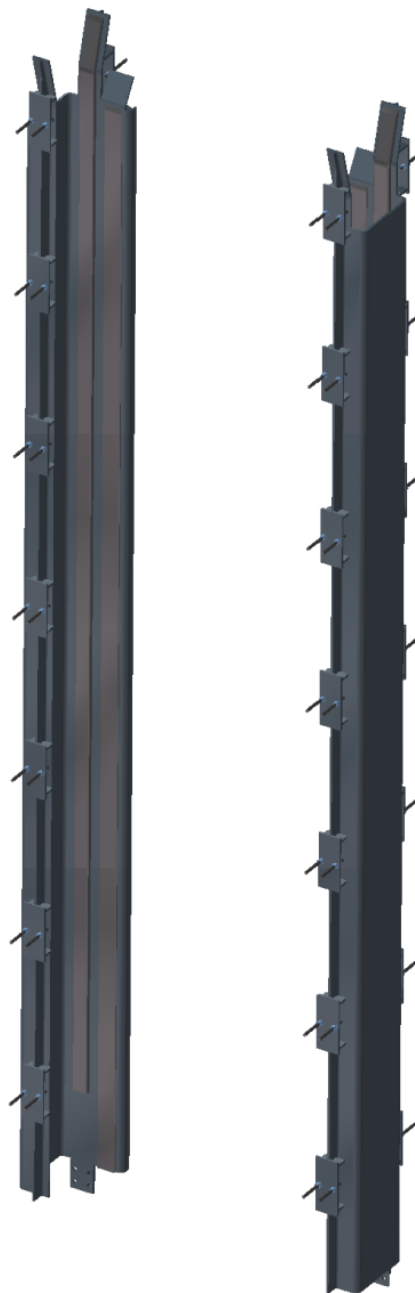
Placas para la instalación de los hierros fijos en la compuerta canal
